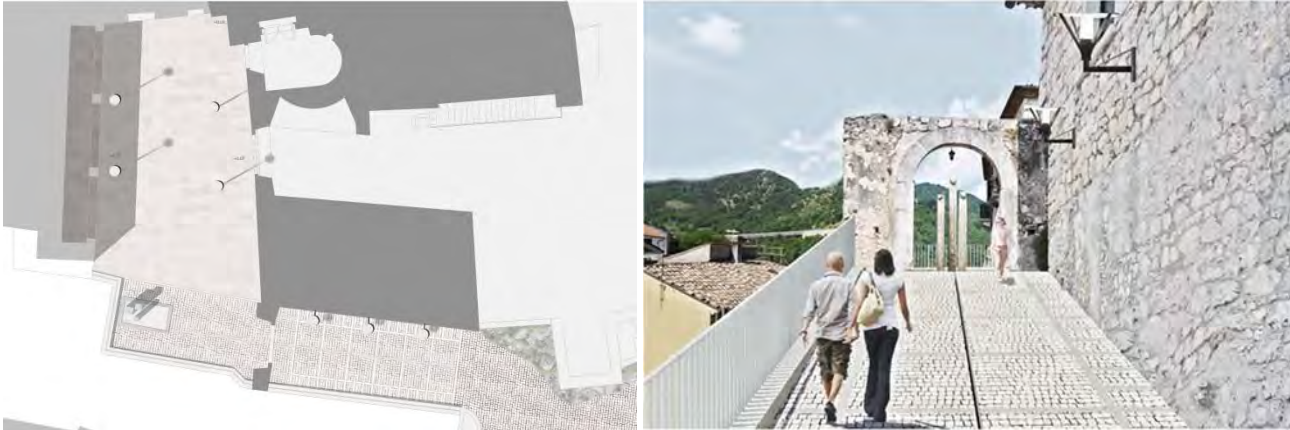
Pianta e vista della nuova sistemazione della Corte Cavaniglia e della rampa di accesso
